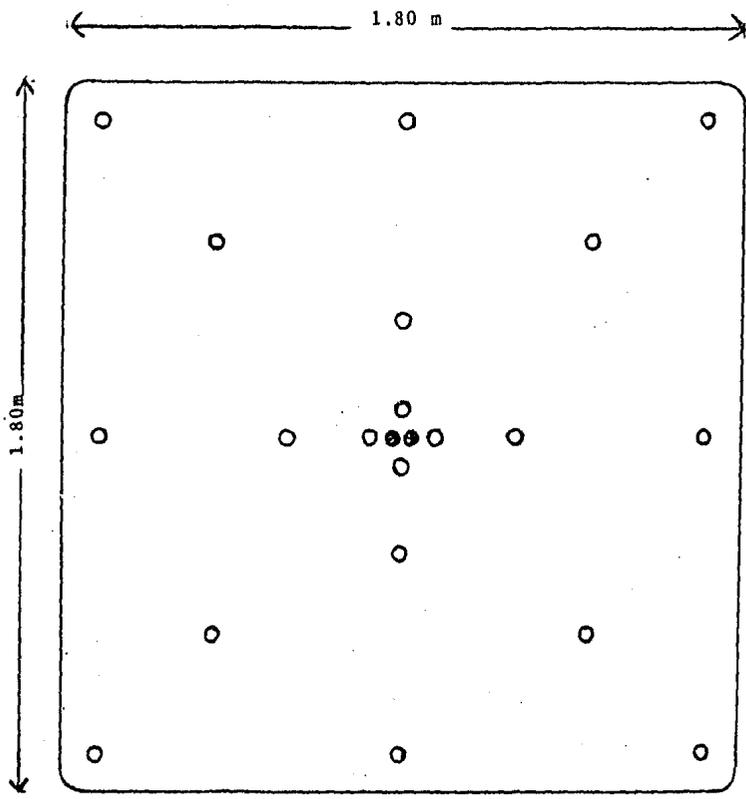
Plantilla de barrenación para contrapozo central en rebajes (tepetatera).
